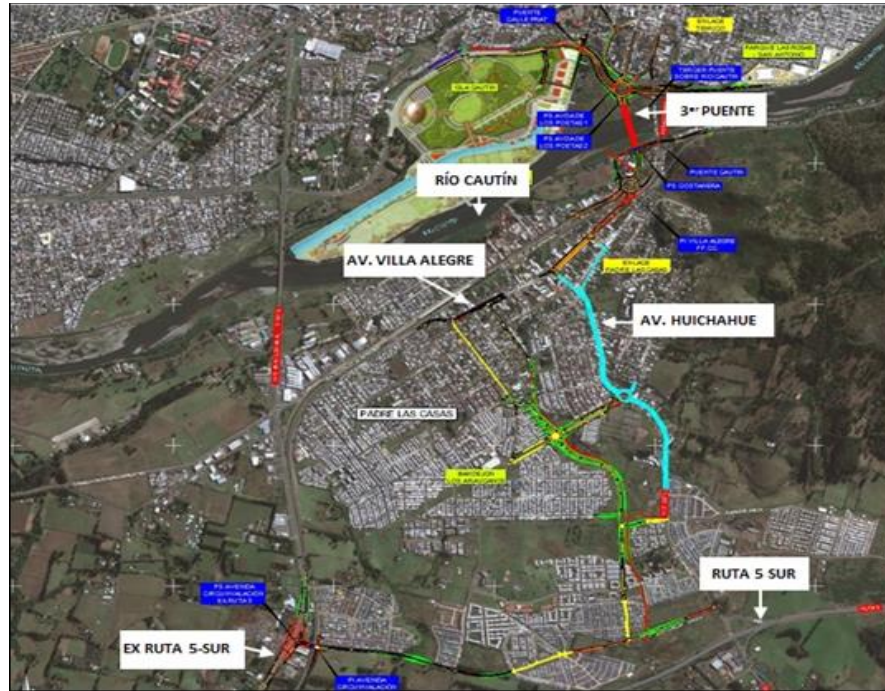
Proyecto interconexión Vial Temuco – Padre Las Casas
